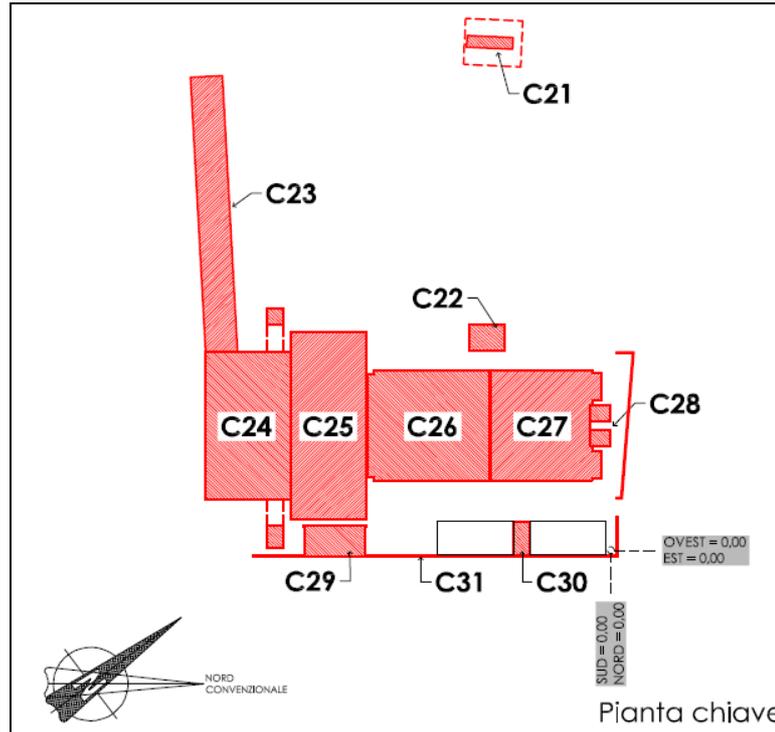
Pianta dell'impianto di termovalorizzazione con indicazione dei fabbricati
